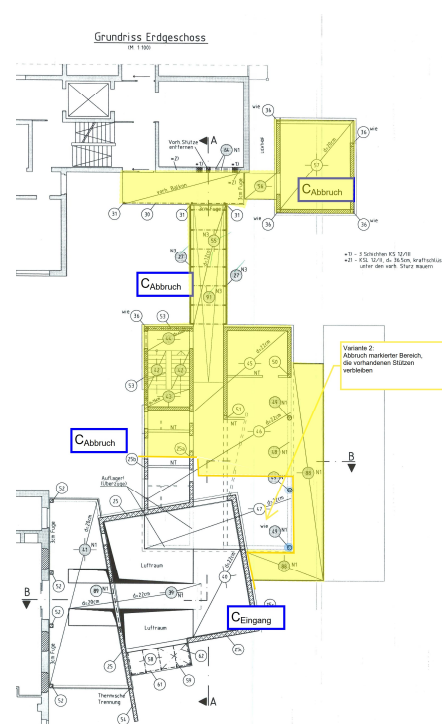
Auszug aus dem Positionsplan Erdgeschoss P3b vom 24.02.2003
